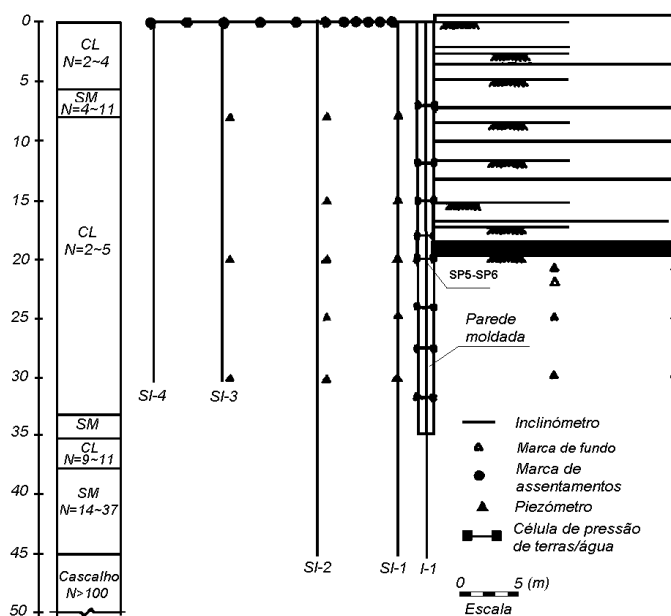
Secção instrumentada – escavação TNEC (Ou et al., 1998)
